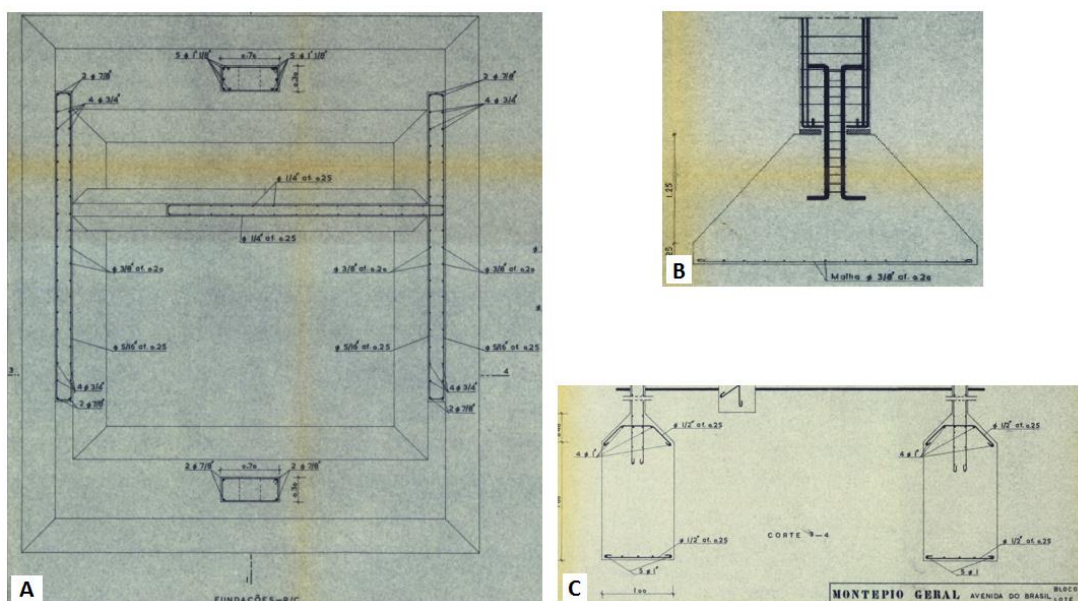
Peças desenhadas: (A) Fundação do núcleo das escadas; (B) Pormenor da fundação de um pilar; (C) Pormenor da fundação das paredes.
